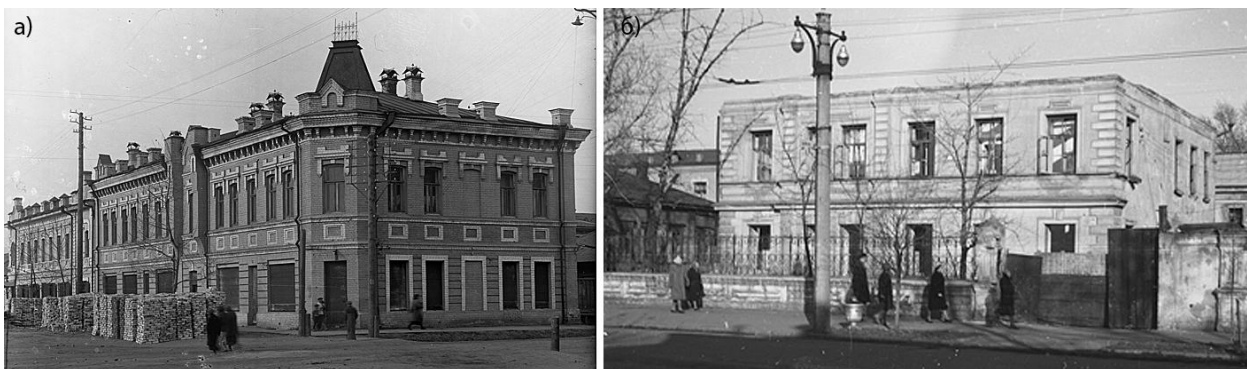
, а) Реконструкция жилого дома по ул. Ленина; б) Реконструкция жилого дома по ул. Советская. Фото 1935 г., ККМ
